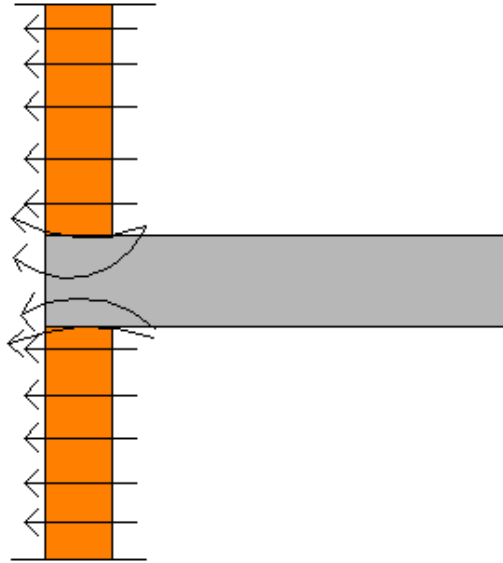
Ponte Térmica devido à ligação da laje com a fachada [2]
